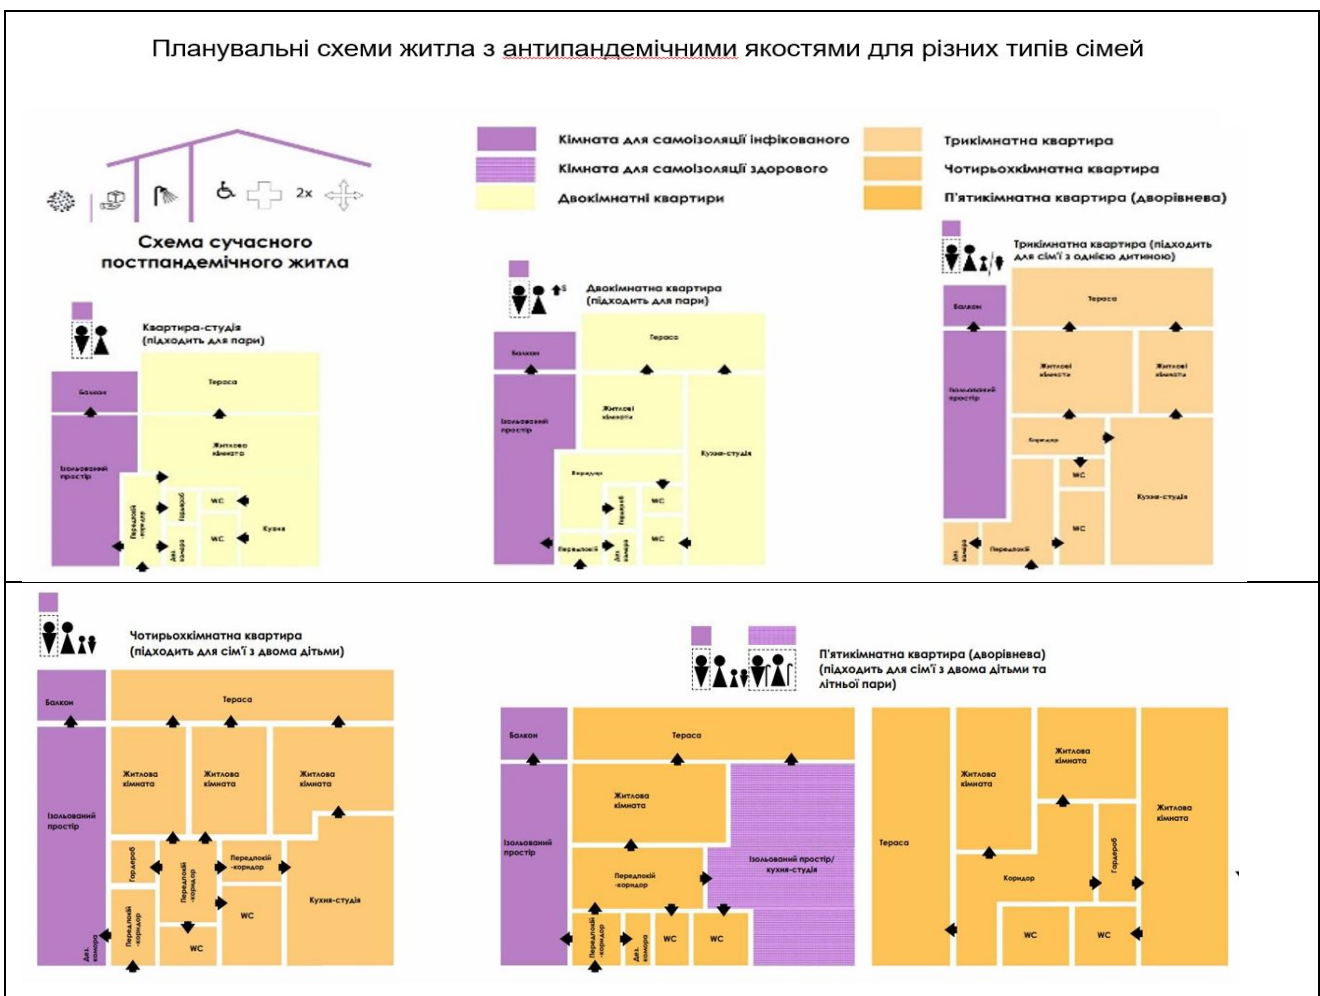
Планувальні схеми квартир з ізолятором для інфікованого.
